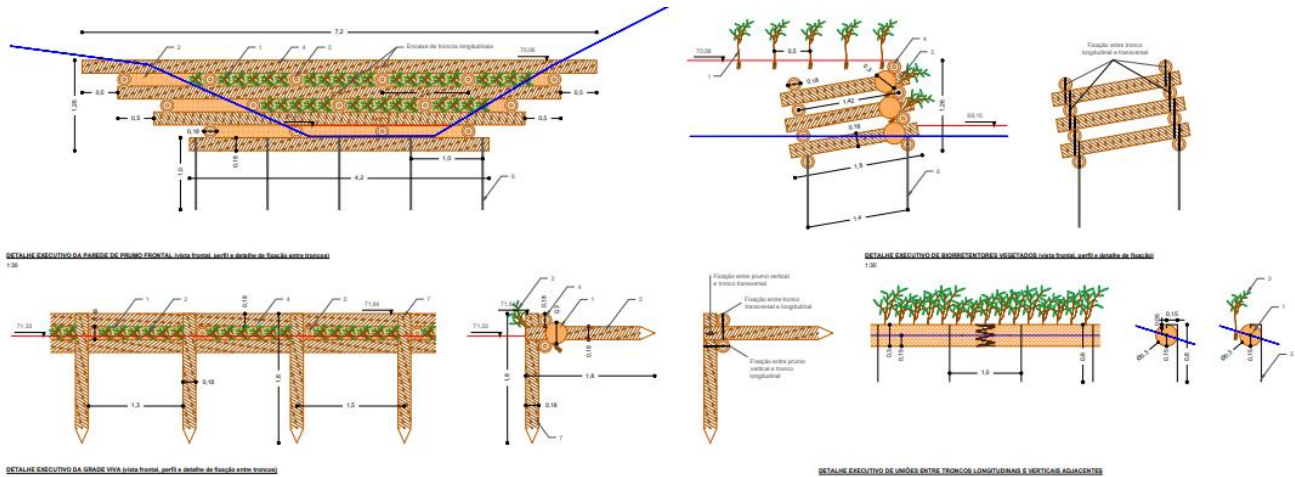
Dimensões e detalhes construtivos da grade viva.
